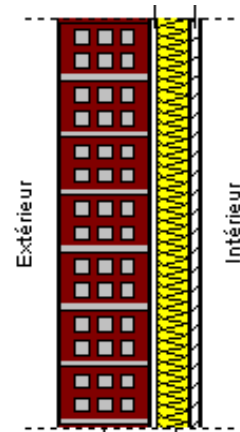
Mur de façade à double paroi, constitué d'une paroi en maçonnerie apparente et d'une contre cloison ⁽¹⁶⁹⁾
